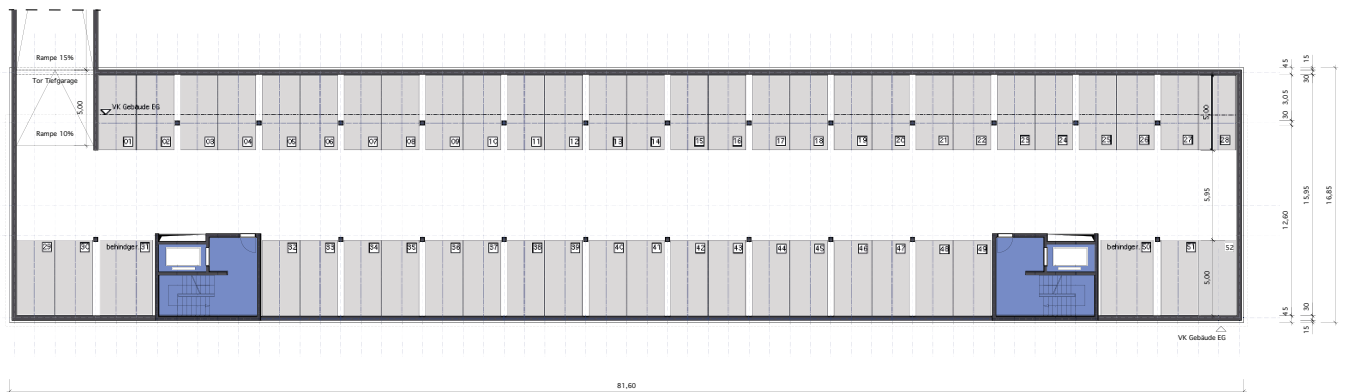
Grundrisse Referenzgebäude „mittlere Variabilität“ für eine Hotelnutzung
